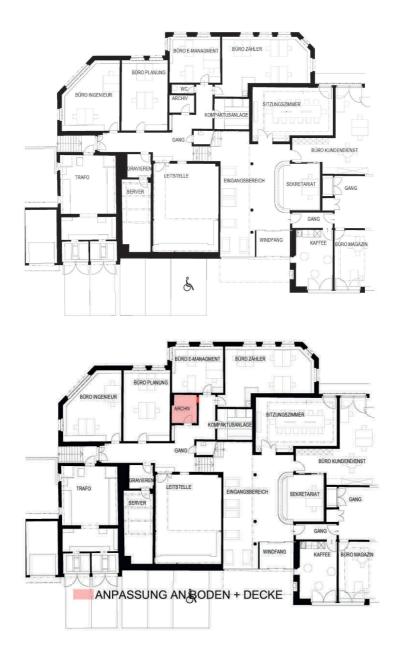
Untergeschoss (oben: bestehend / unten: neu)
